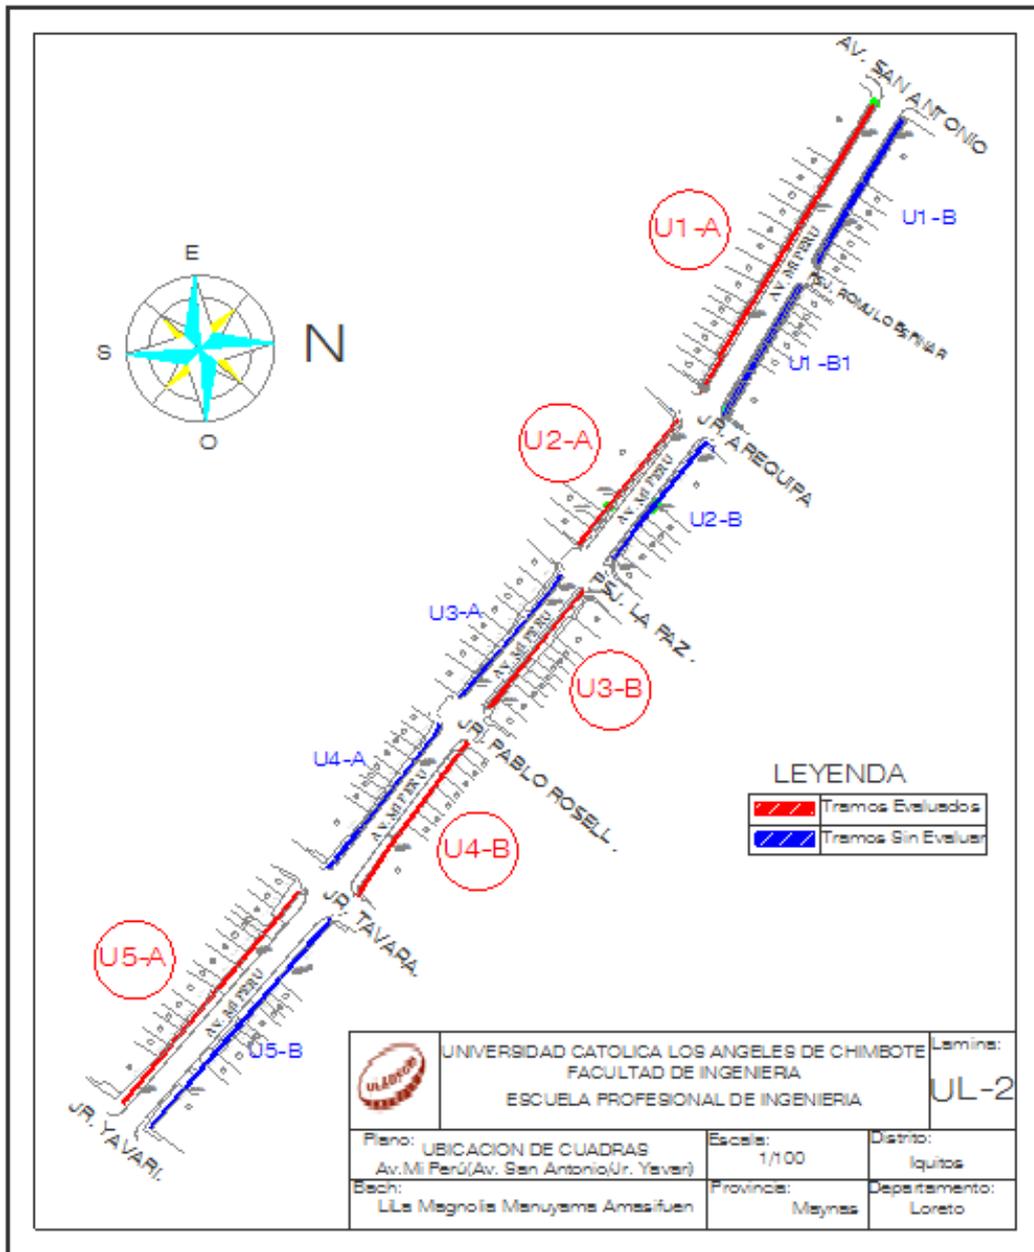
Plano de Ubicación de Cuadras de la Avenida Mi Perú.
